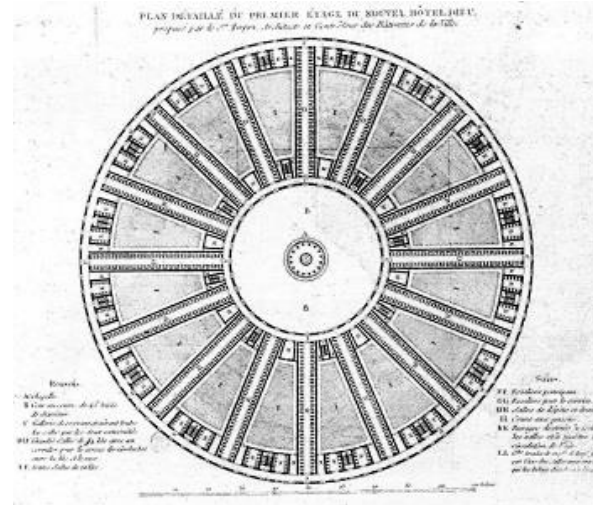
Bernard Poyet, Planta detallada del Primer piso del nuevo Hotel-Dieu, 1785.
